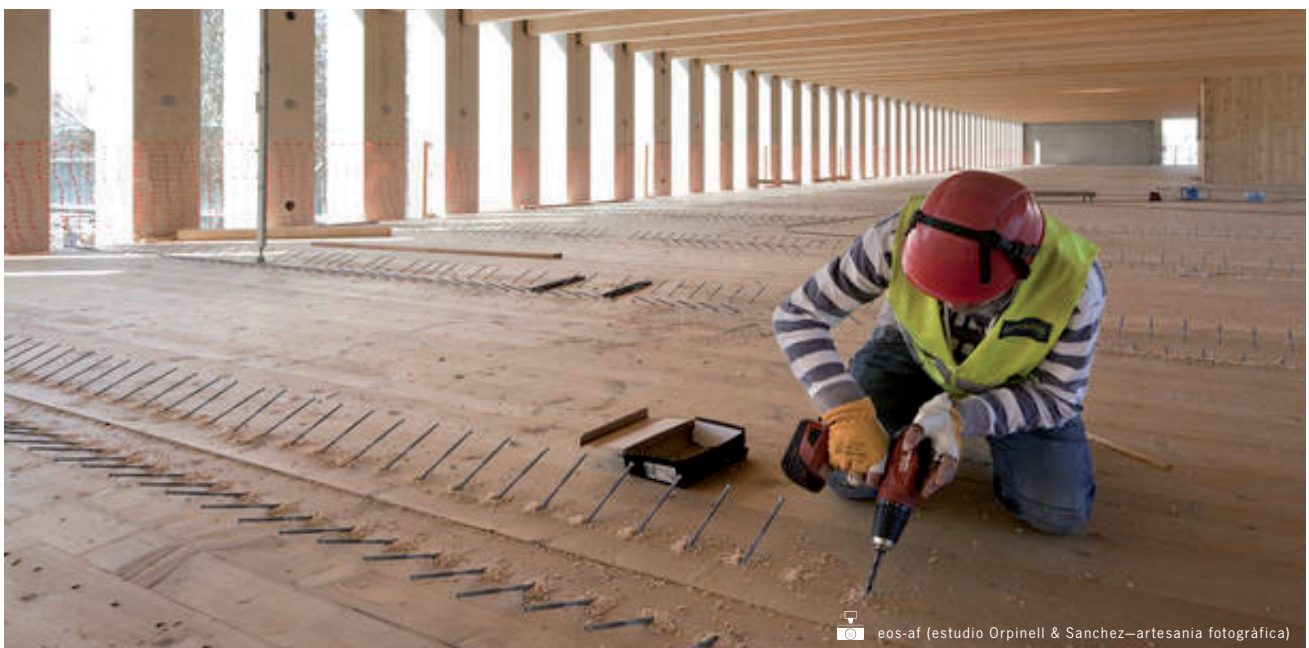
Elementverbindung mit verschraubtem Deckbrett
